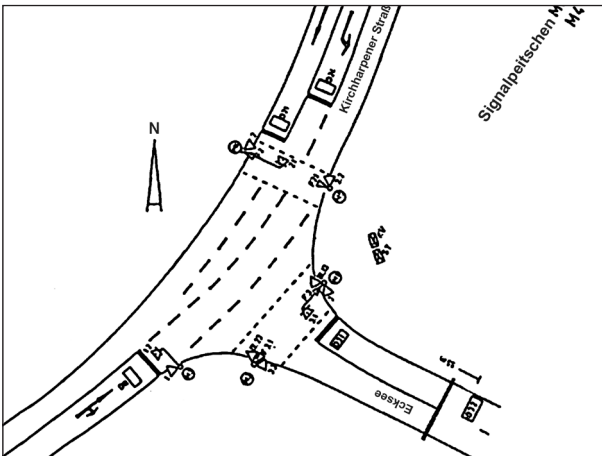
Signallageplan des Knotenpunkts Kirchharpener Straße/Ecksee in Bochum
